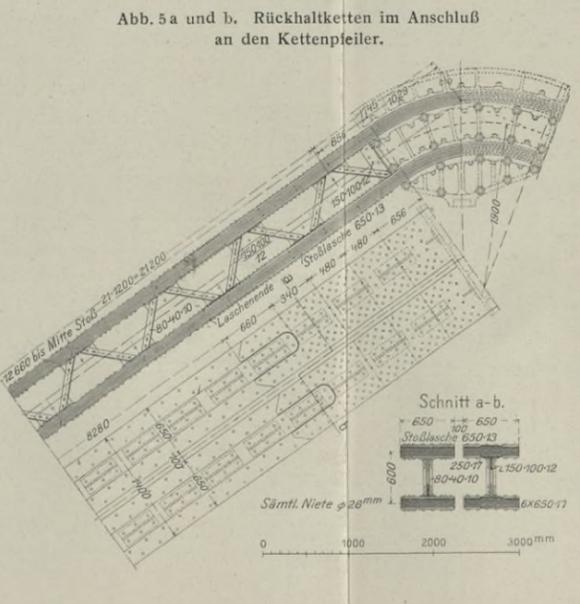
und b. Rückhaltketten im Anschluß an den Kettenpfeiler.
